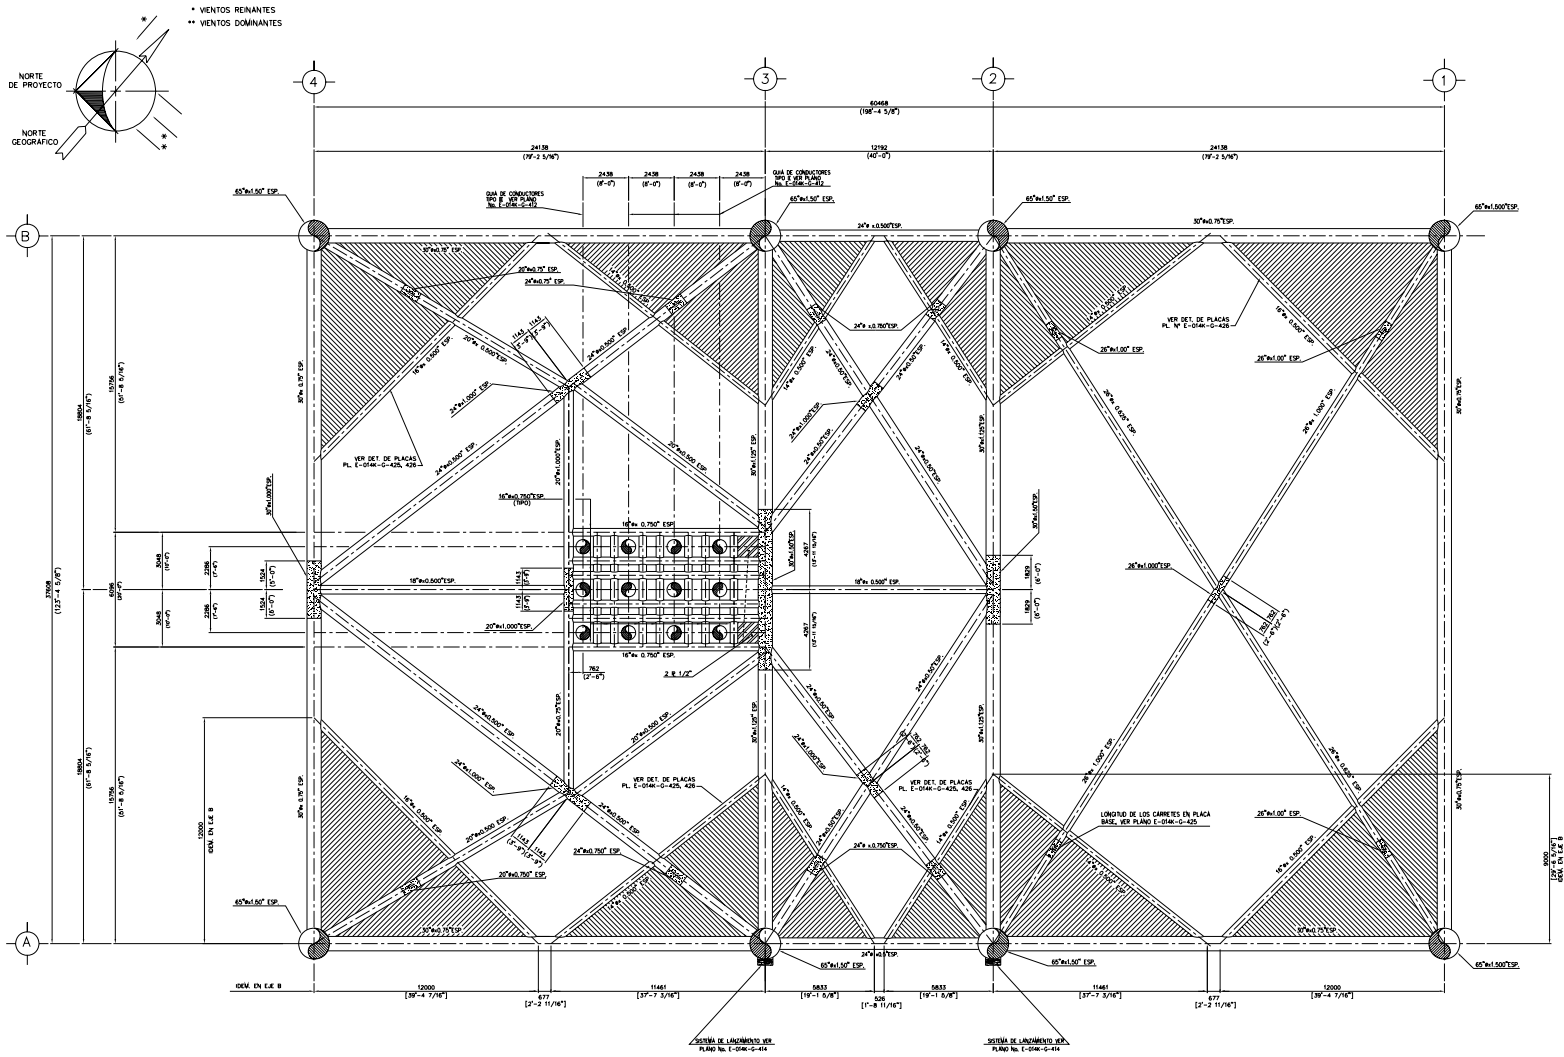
Planta en elevación (-) 85.000 m (278'-10 7/16").
